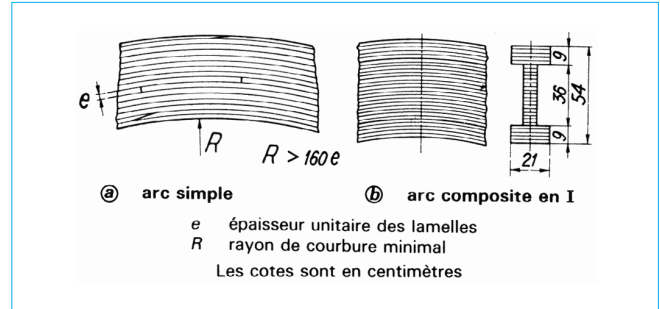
Arc lamellé (fabrication par encollage sur cintre)
